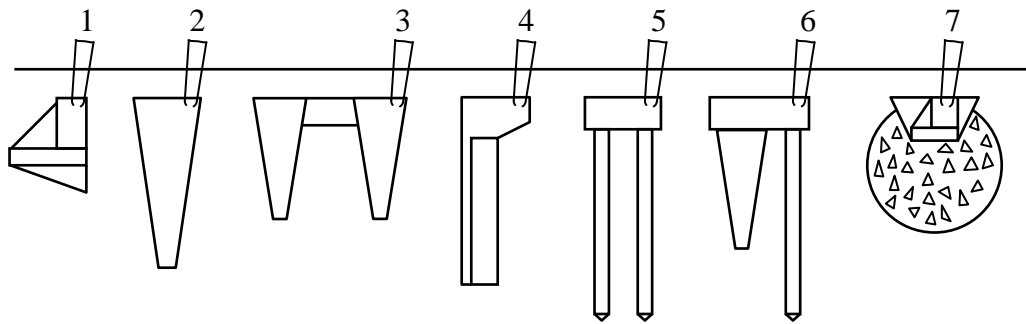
Фундаменти під стояки несучих розпірних конструкцій:
